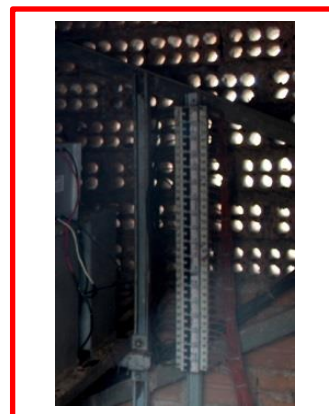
A 217: ESTRUTURA – TORRE 2
